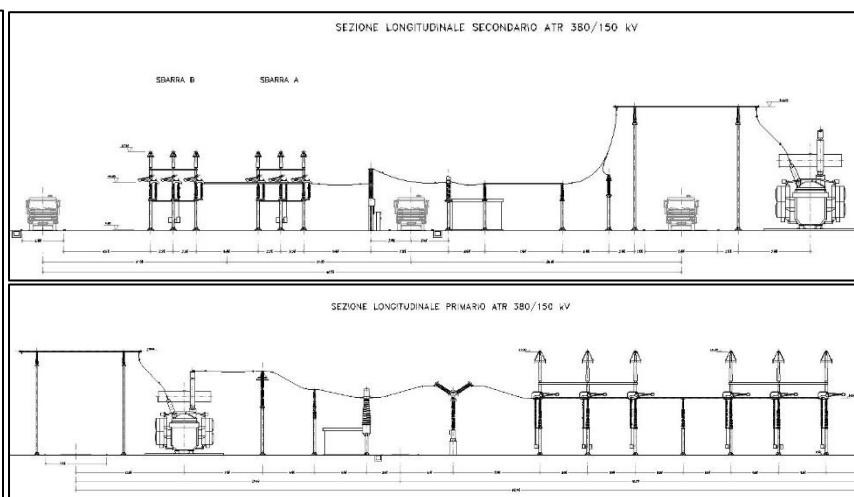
Lay out della Stazione Primaria di Ponte Galeria e sezioni longitudinali ATR 380/150 Kv
